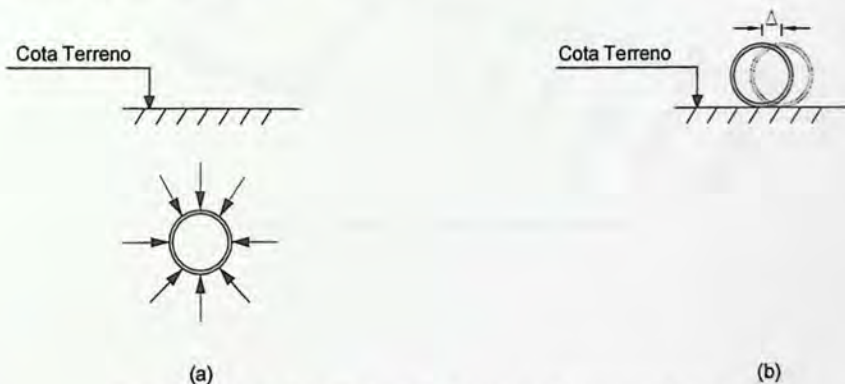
a) Cañería enterrada. b) Cañería apoyada directamente sobre terreno.
